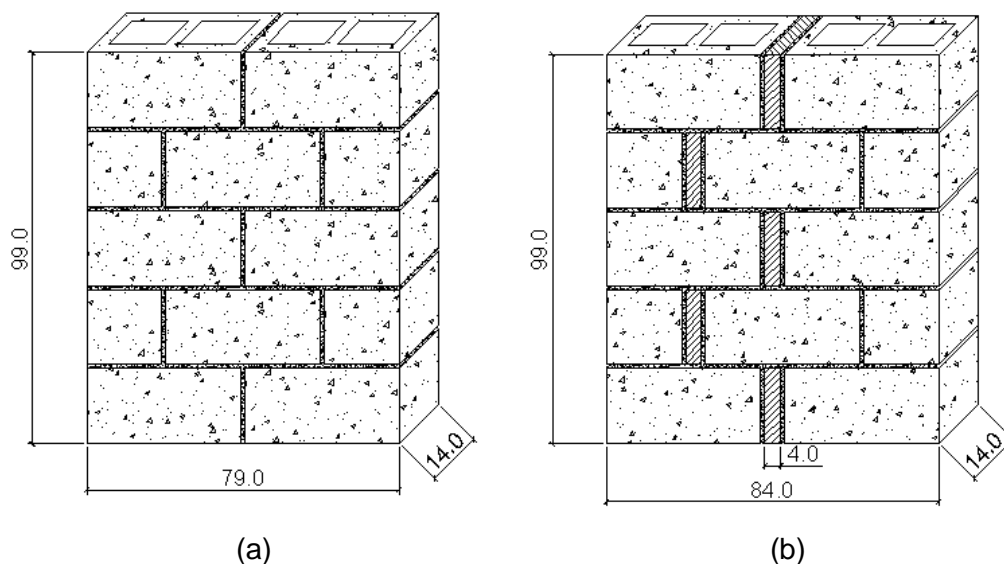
Mini-parede sem rapadura (a); mini-parede com rapadura (b) (medidas em cm)
